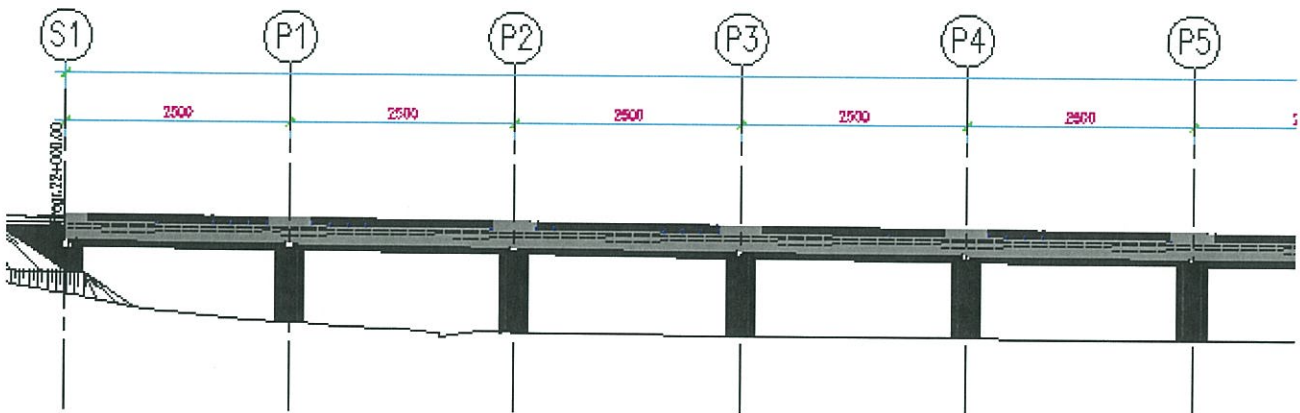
Viadotto Palude Capo d'Acqua: stralcio del prospetto
